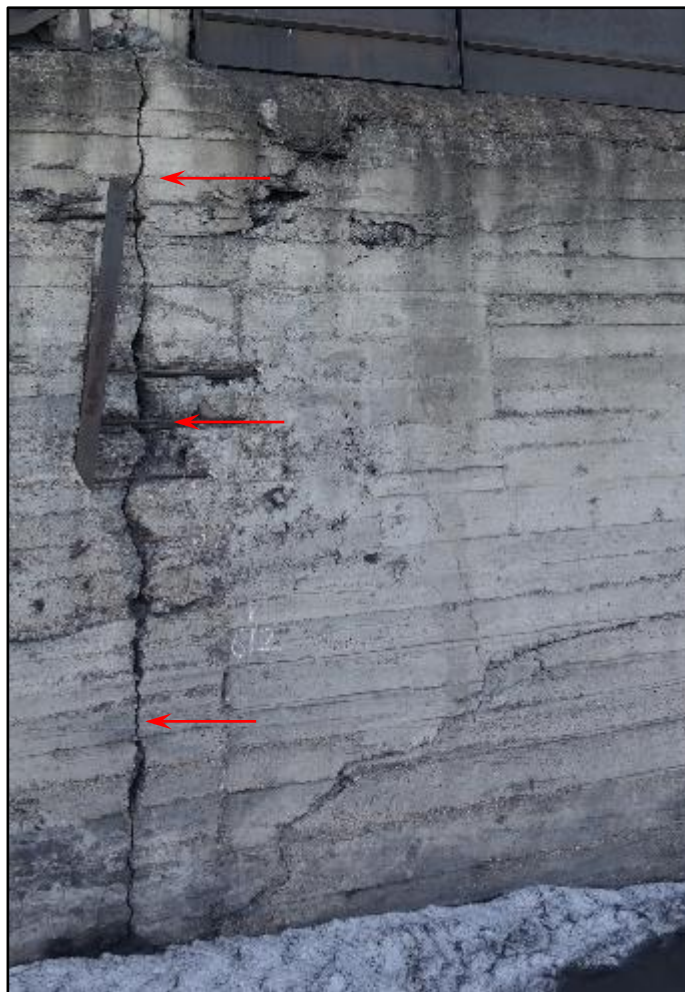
(Разрушение бетона верха монолитной стены осях 20-22/А)
